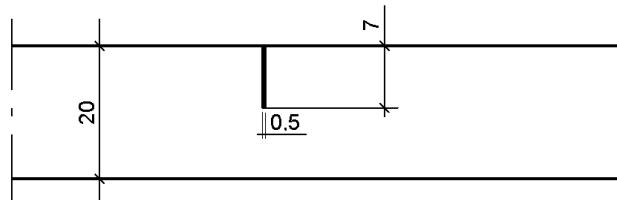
Przykłady konstrukcji szczelin w podbudowie z betonu cementowego (wymiary w cm)
